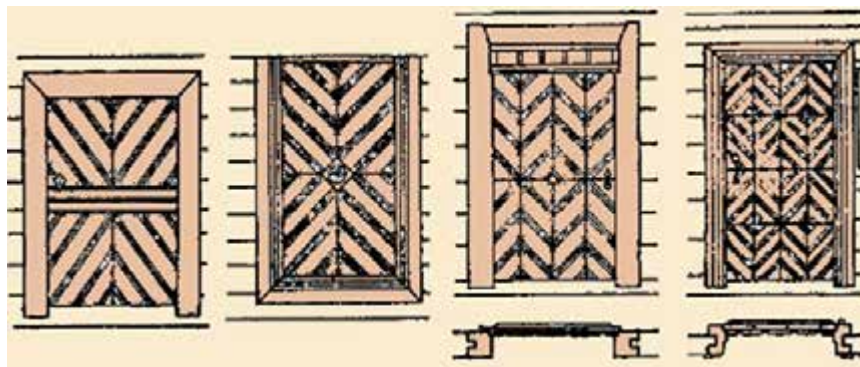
Вхідні двері житлових і громадських будівель з оздобленням в ялинку або в квадрати струганими профільними рейками або дошками, з'єднаними в чверть, у шпунт і гребінь або впритул.
